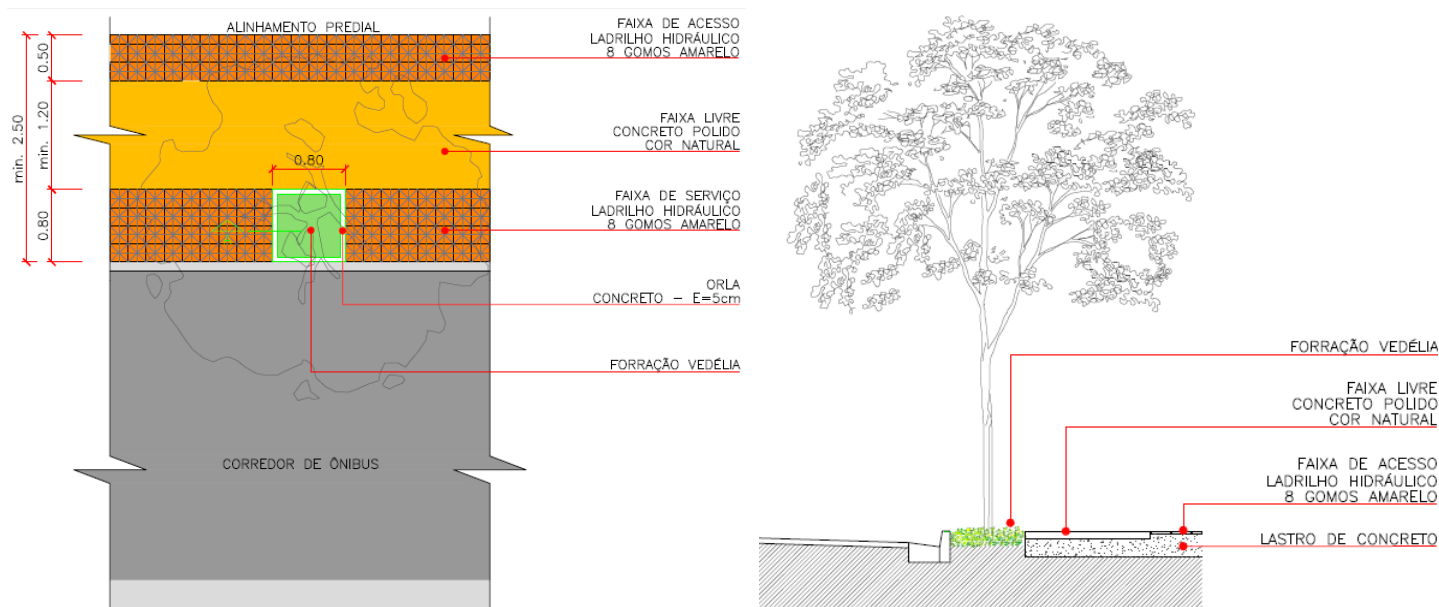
Detalhe típico de canteiro implantado na faixa de serviço
